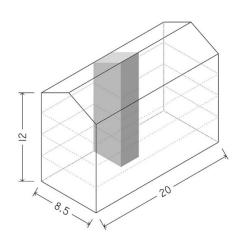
Volumetría tipo con escalera centrada Fondo: 8,5,m/Ancho: 20m/Altura cornisa:12m
